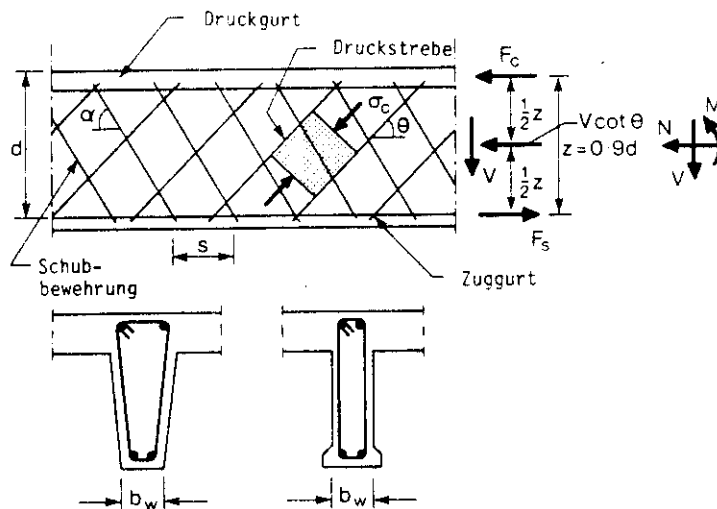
Bezeichnungen für querkraftbeanspruchte Bauteile
